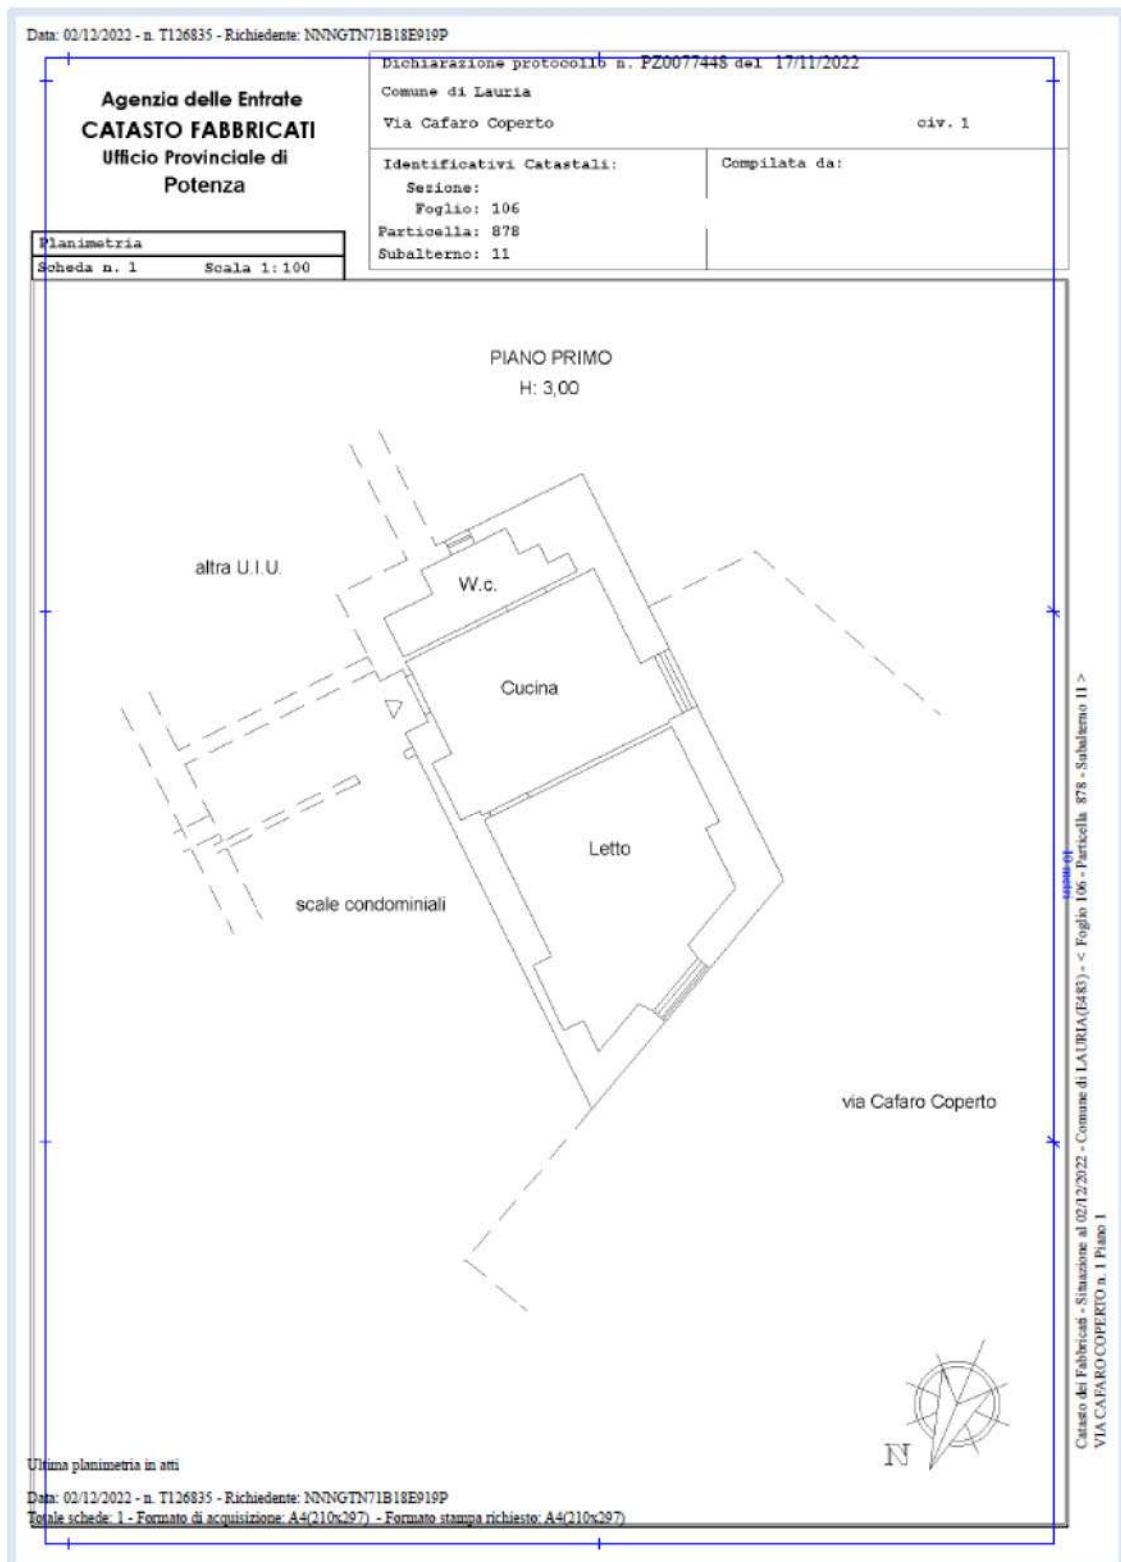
Planimetria “aggiornata” Unità Fg. 106 P.IIa 878 sub. 11
